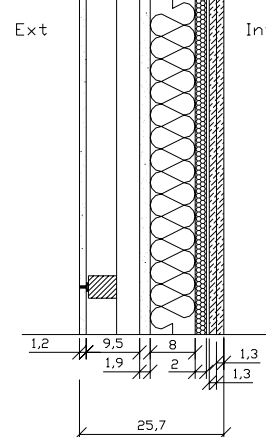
Parede tripla leve composta de painel sandwich e painel de revestimento ventilado
